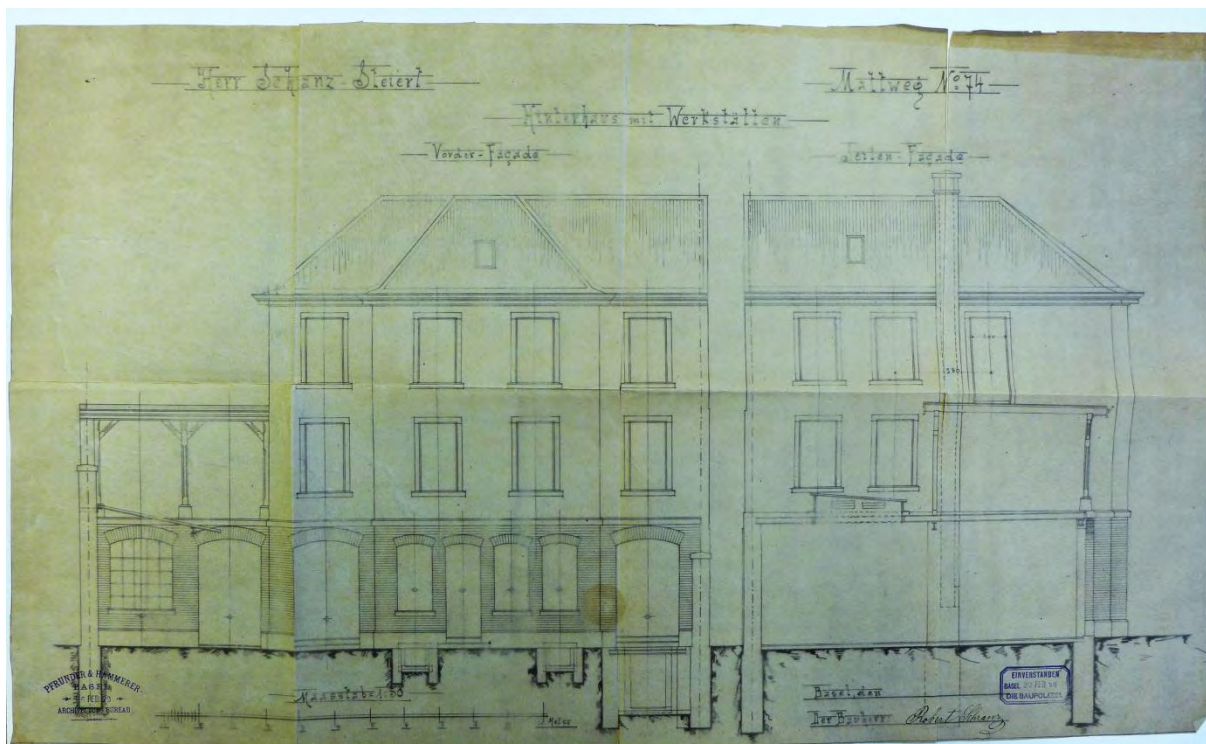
Fassade des Wohnhauses nach den abgeänderten und ausgeführten Plänen von Pfrunder und Hammerer
